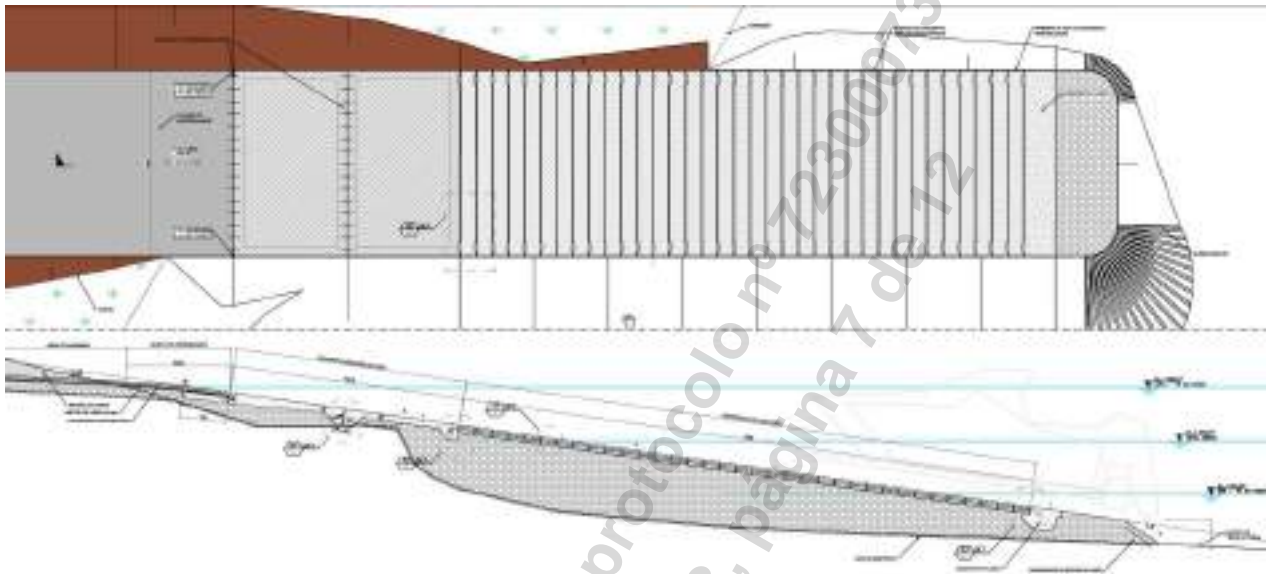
Planta e seção transversal – Rampa de acesso de embarcações
